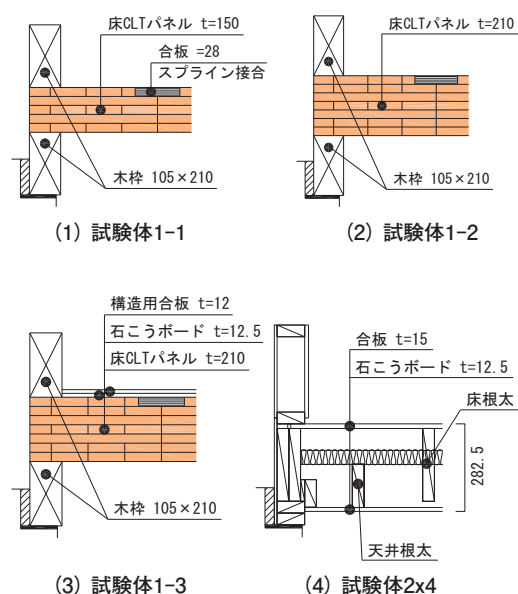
試験体1-1～1-3、試験体2x4の断面図(寸法単位:mm)
